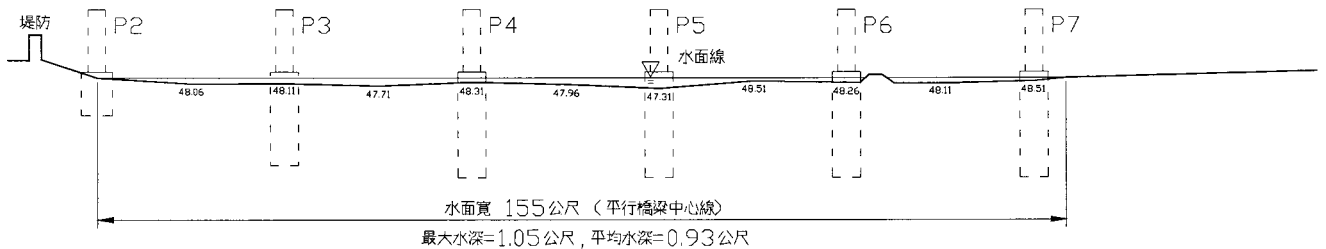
橋梁中心線下游 25 公尺河床斷面圖 (水平 : 垂直=1 : 1)
